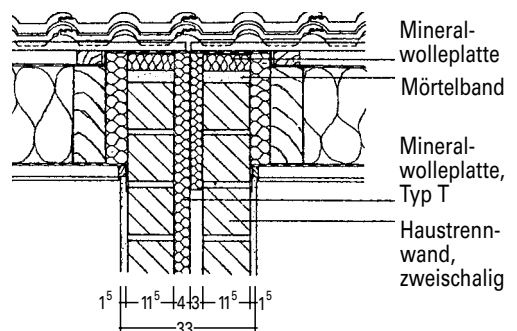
Vertikalschnitt: Haustrennwand/Dach
